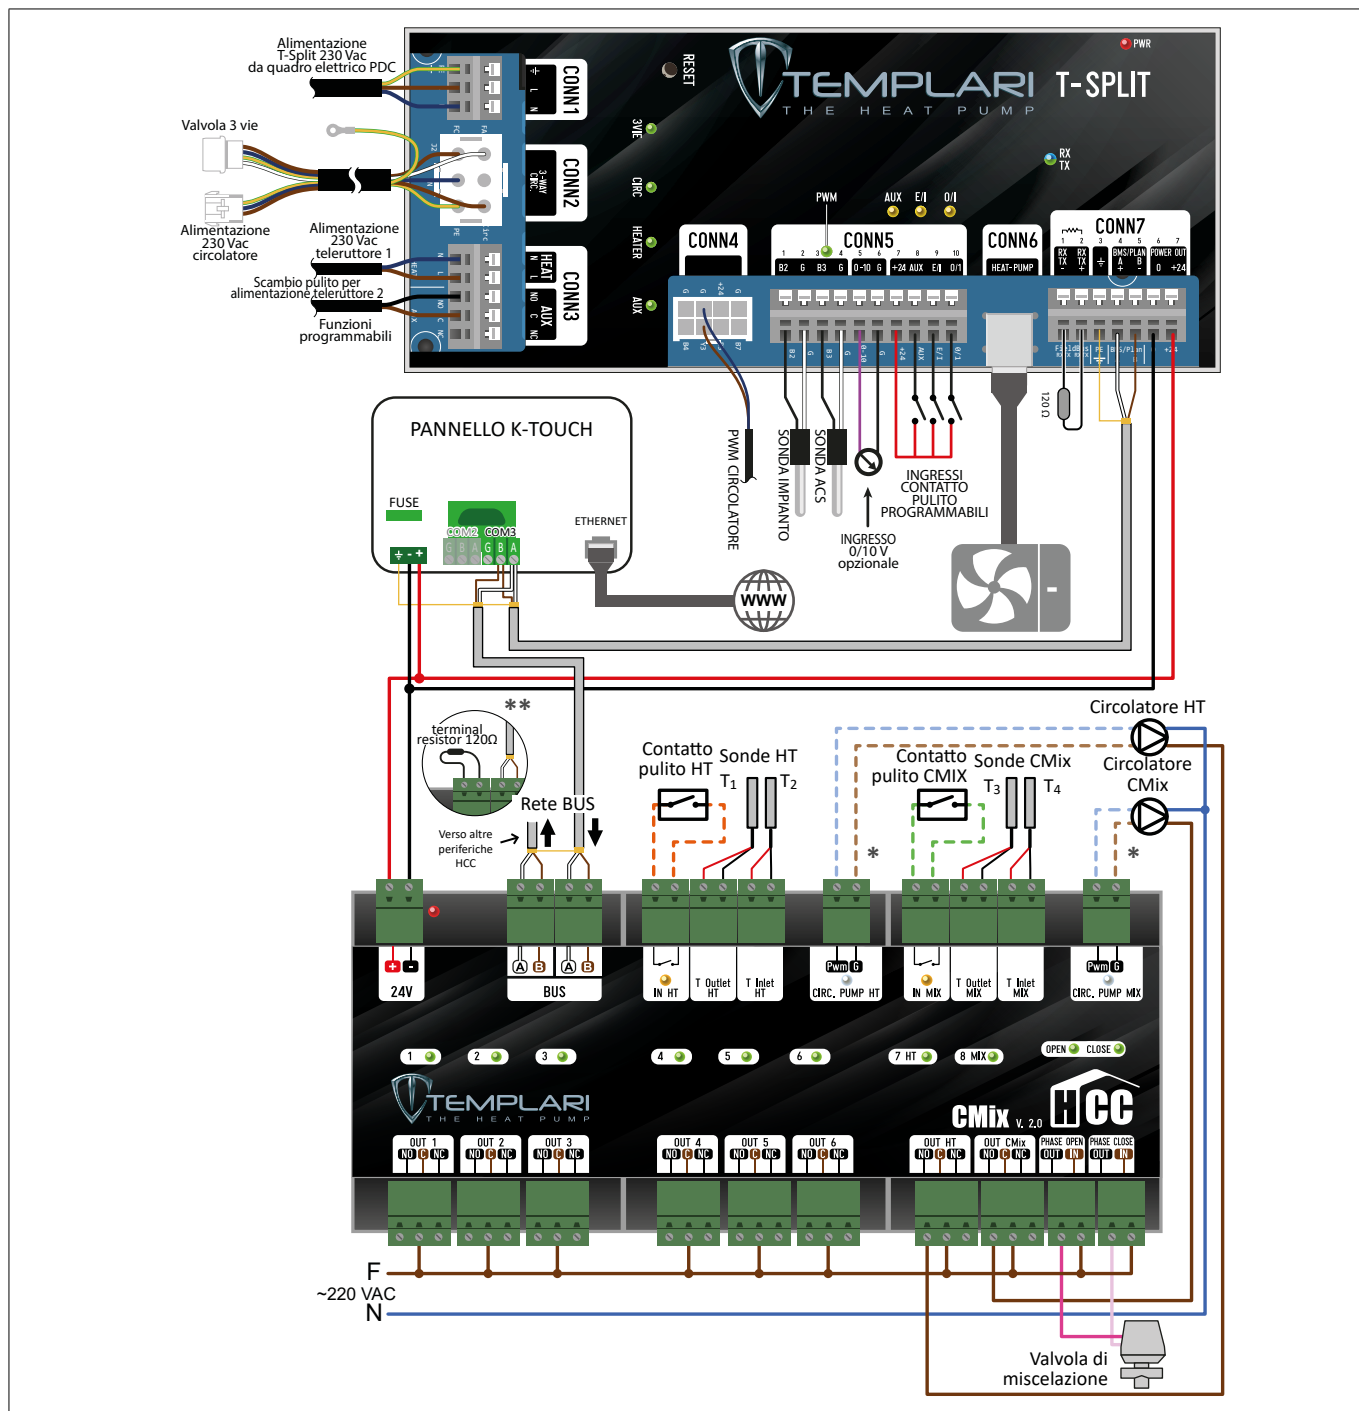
(Schema elettrico di collegamento modulo CMix)
